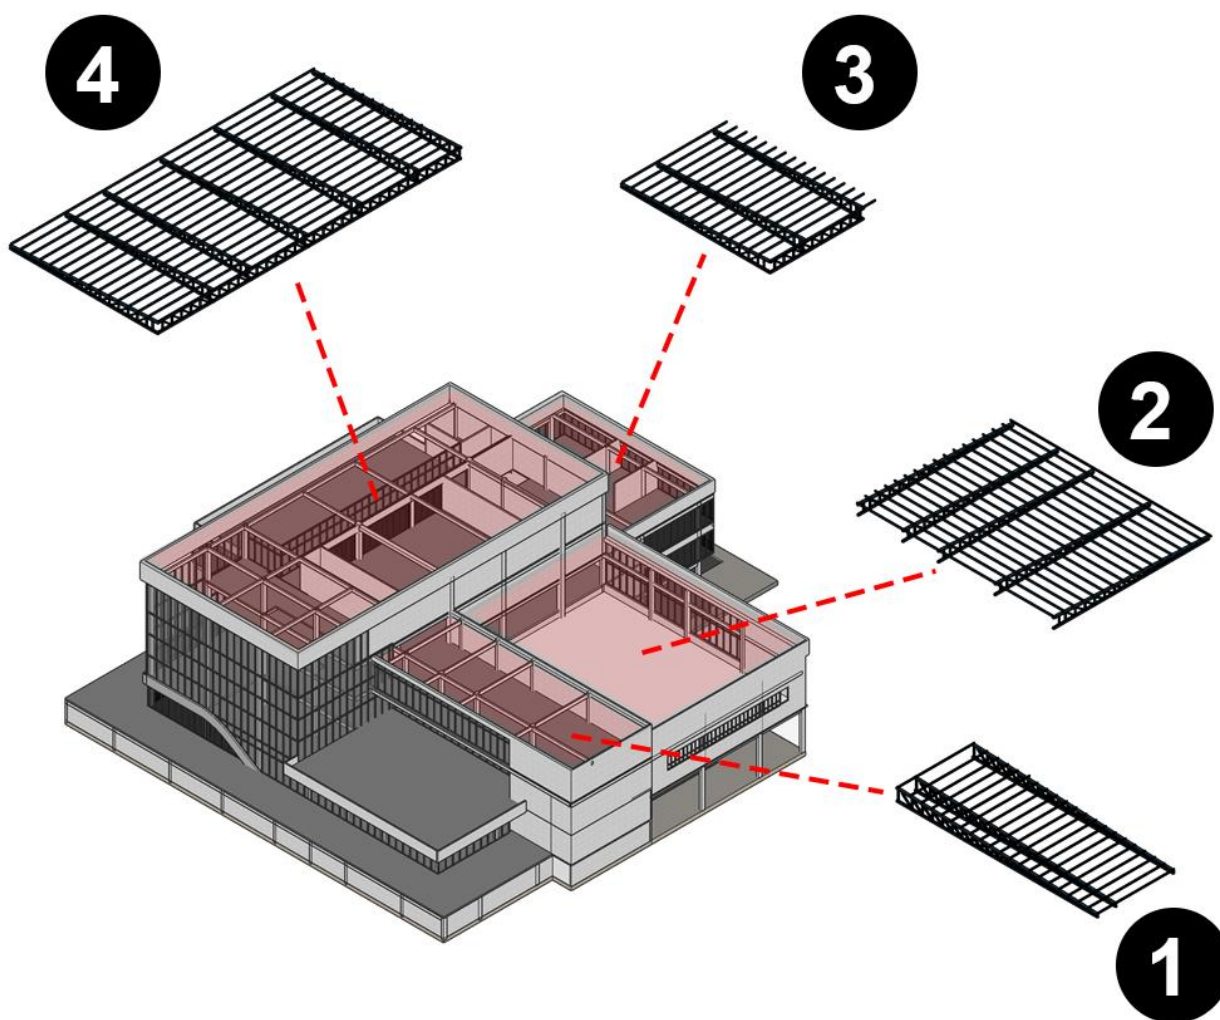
Diagrama constructivo nivel 4.60, Elaborado por el autor
